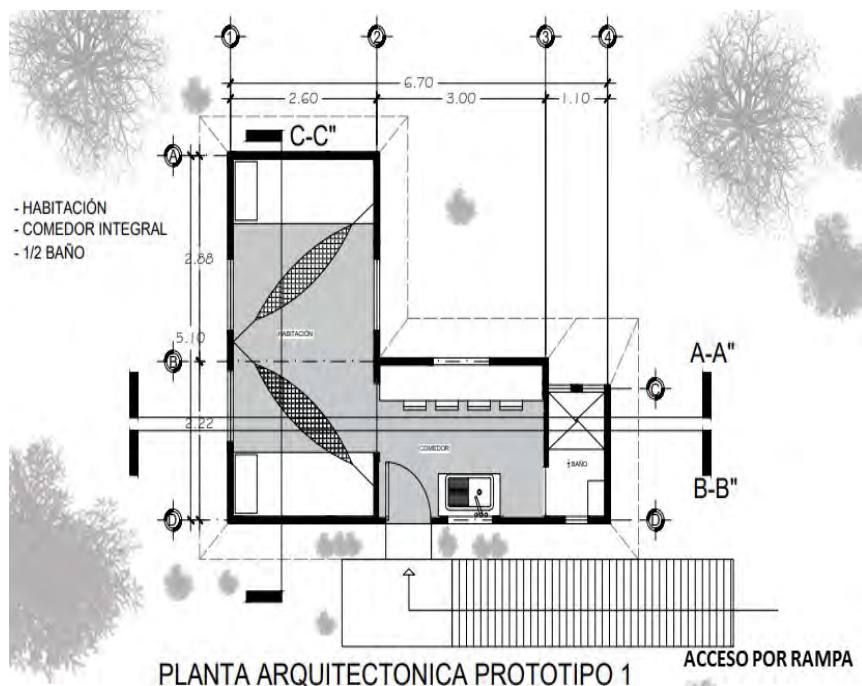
Módulo de vivienda tipo (prototipo 1).
